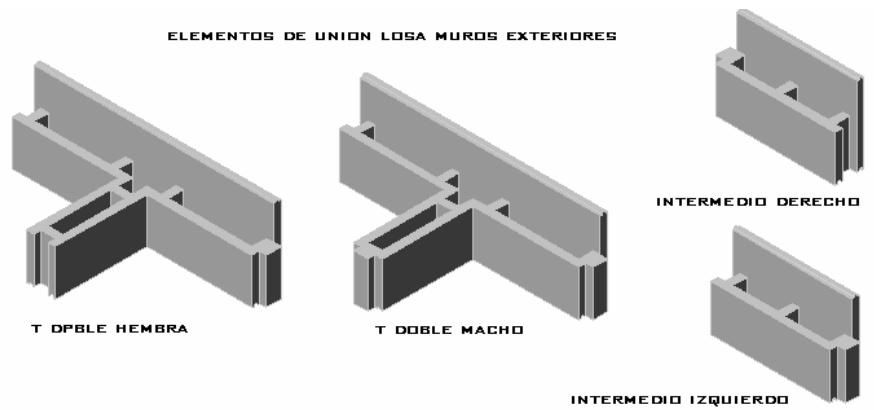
ELEMENTOS UNIÓN LOSA MUROS
